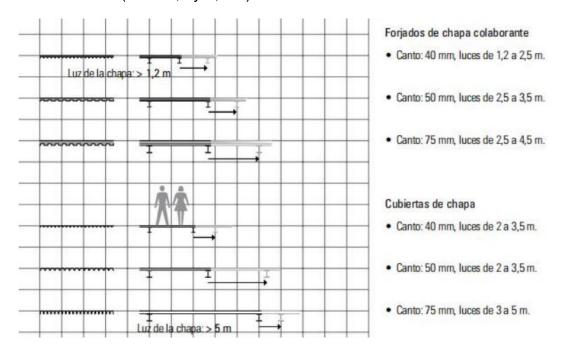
Cantos según luces losas y cubiertas de chapa de acero.
